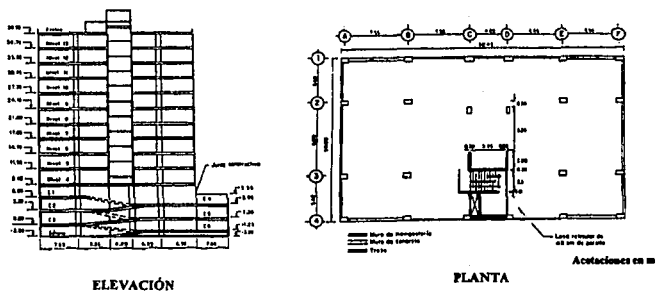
Elevación y planta típicas del edificio Jalapa.
